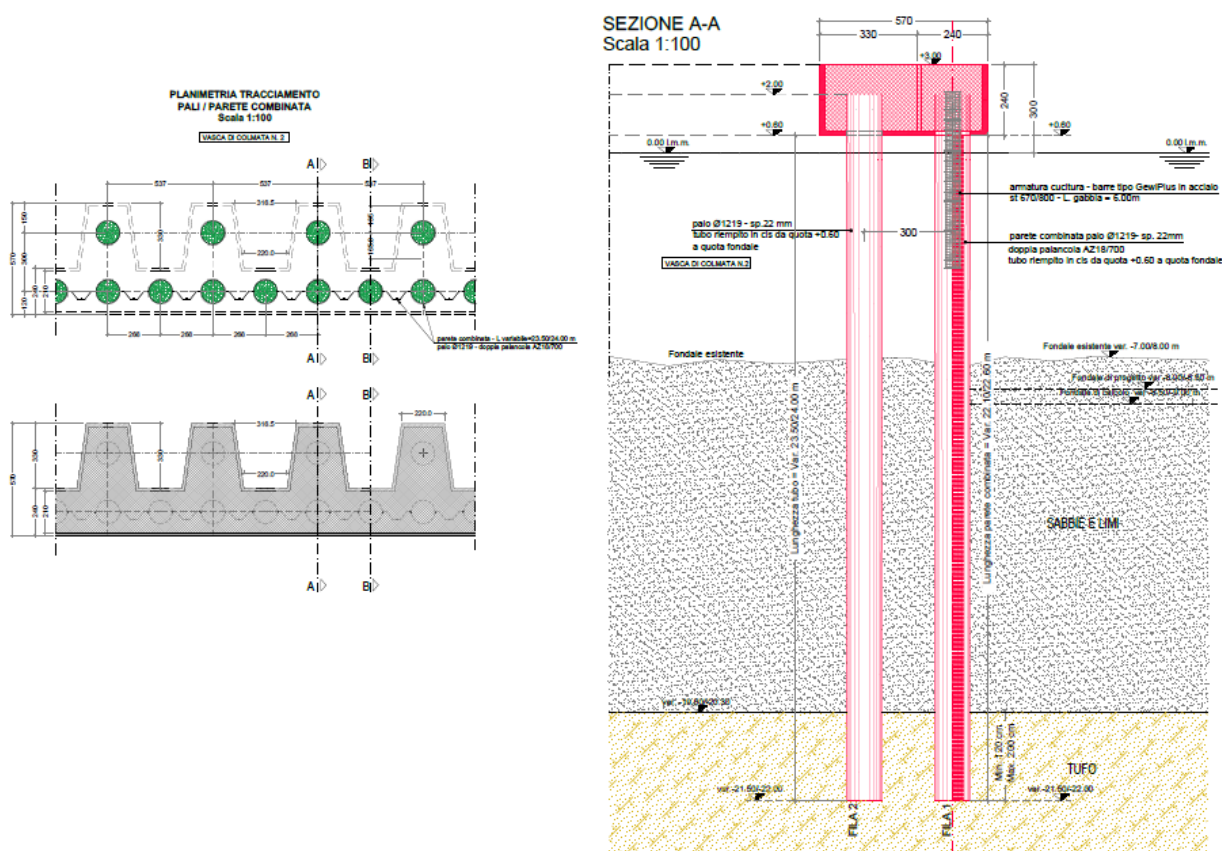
Sezione tipologica di progetto tratto A (stralcio elaborato MI061P-PDDS4022 - Progetto cassa di colmata – Sezioni)
